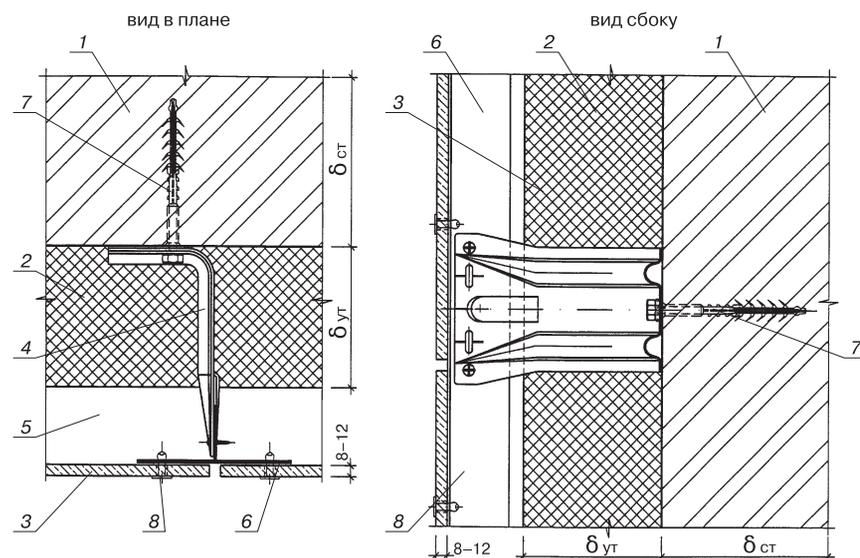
Система утепления стен с защитным экраном (стеклофибробетонные плиты).
